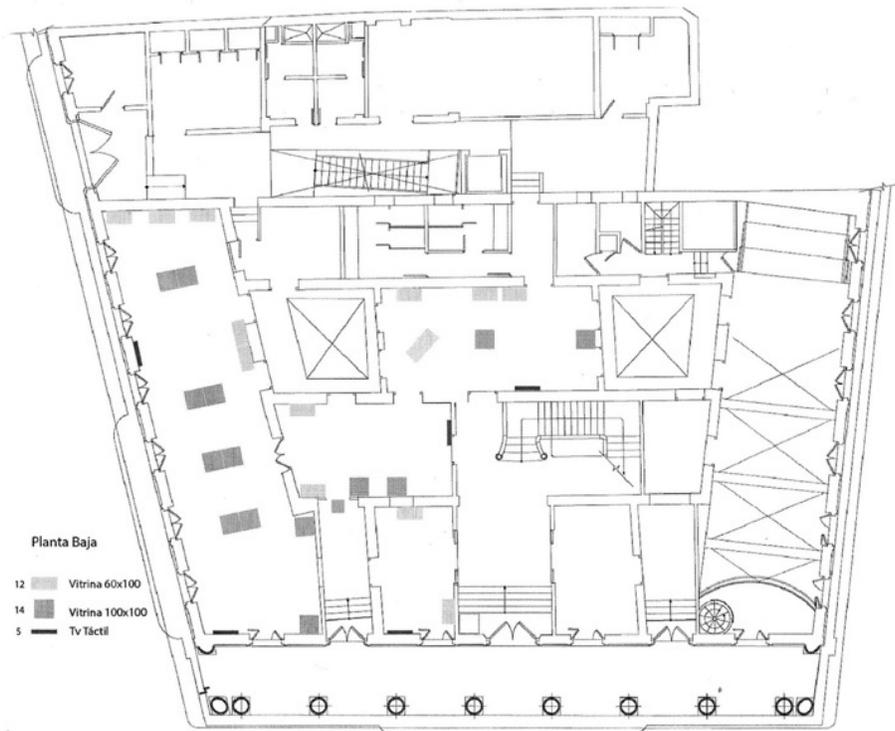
Distribución de vitrinas y pantallas en la planta baja. Museo Nacional de la Música.
